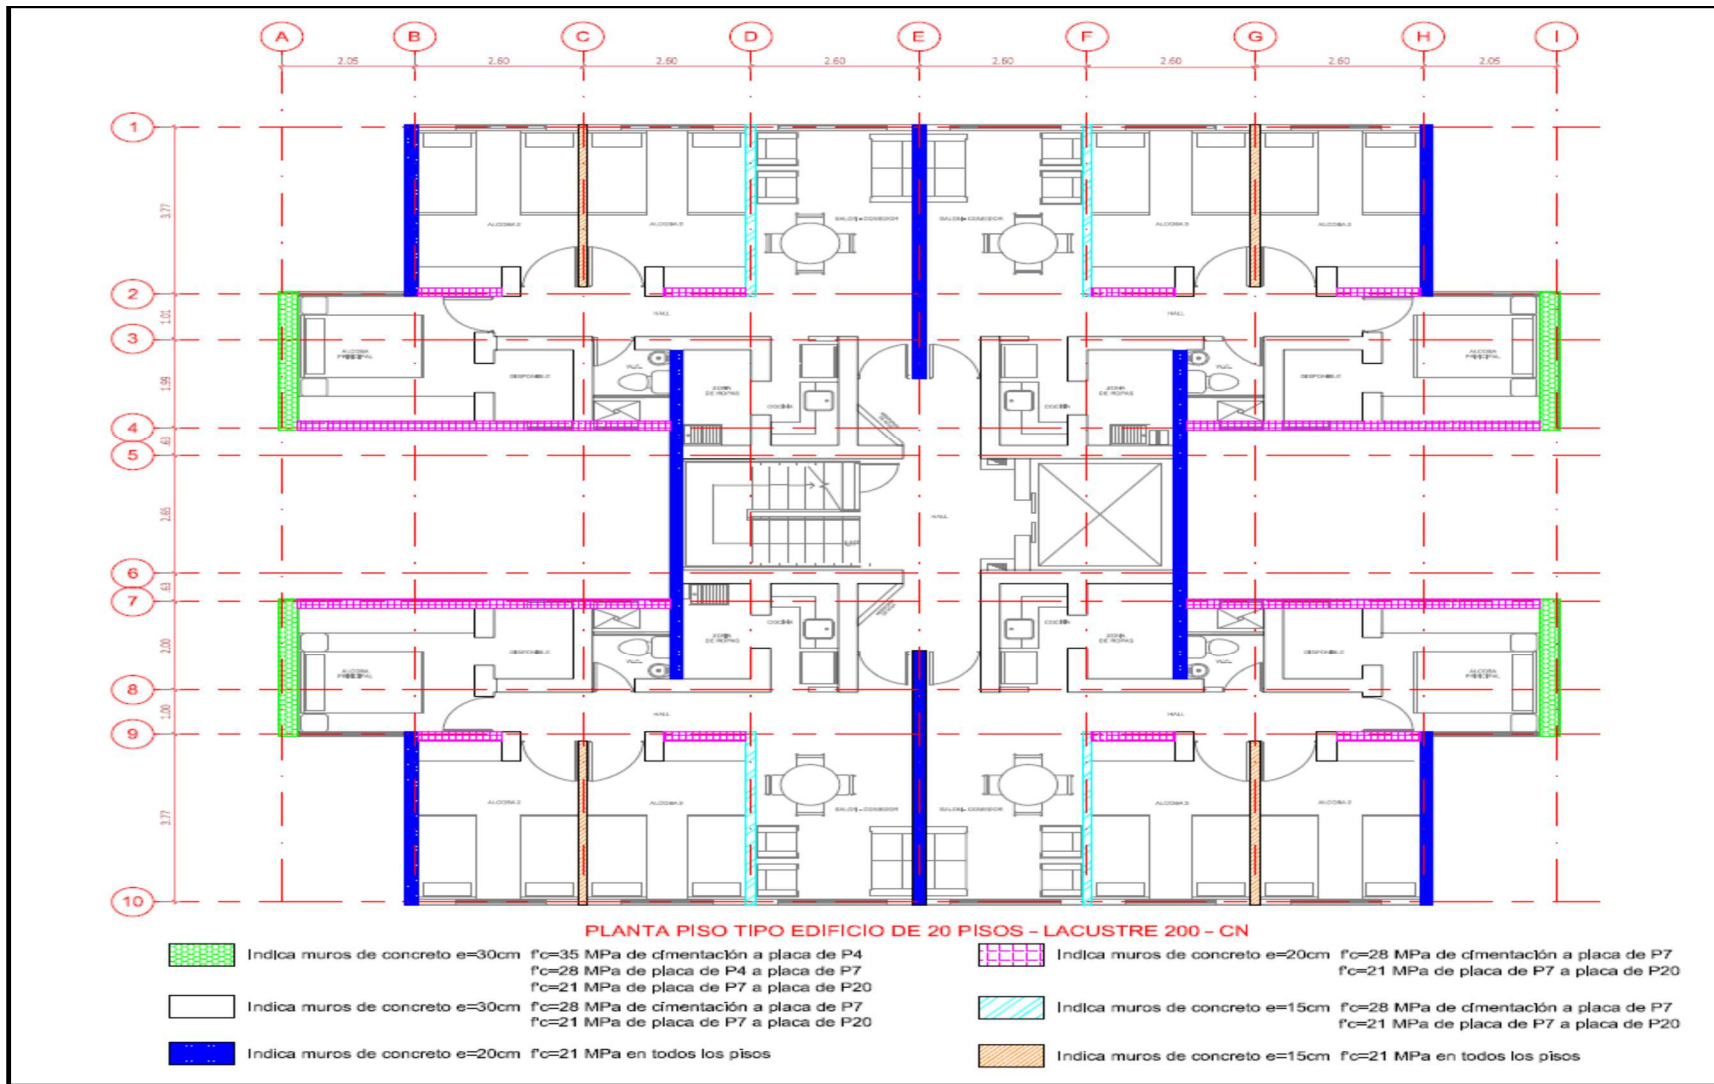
Planta piso tipo edificio de veinte pisos – Lacustre 200 CN. Elaborada por la autora
